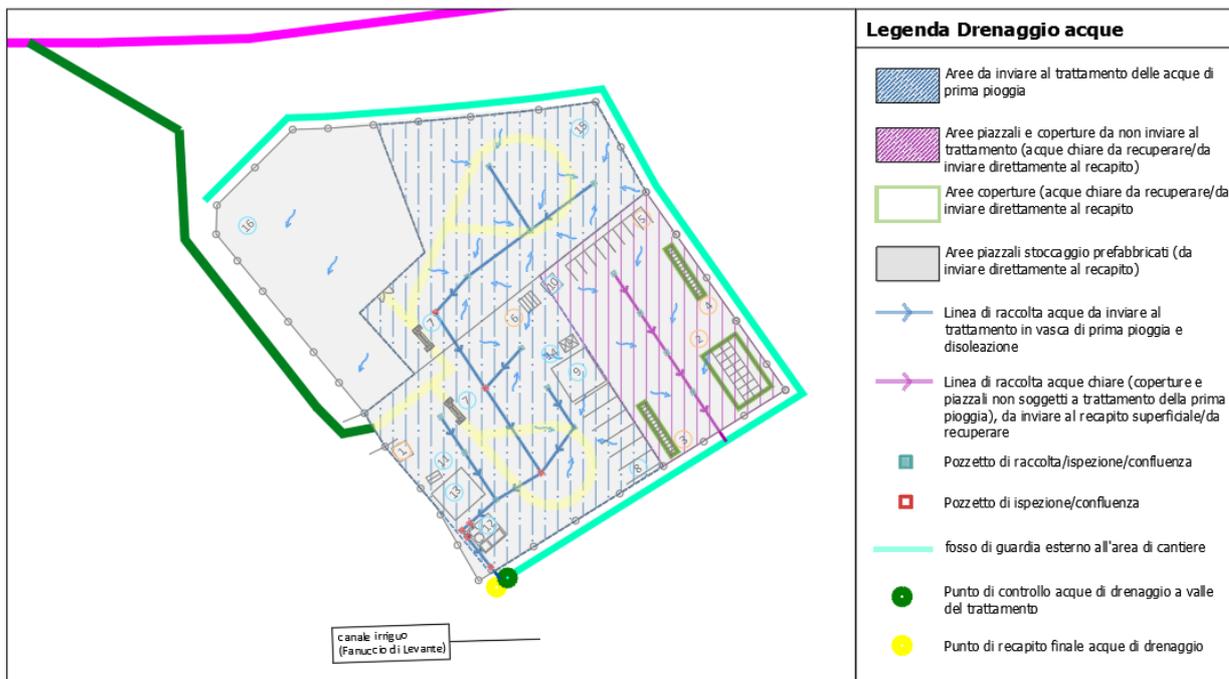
Sistema di gestione delle acque di cantiere: CO_02
